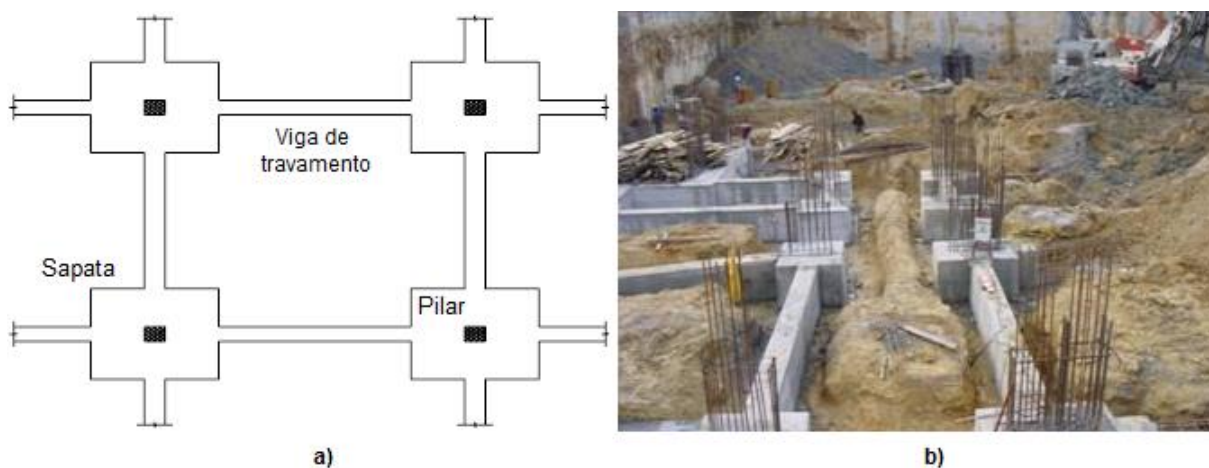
Agrupamento de sapatas através de vigas de travamento: a) representação; b) construção [adaptado de 46]
